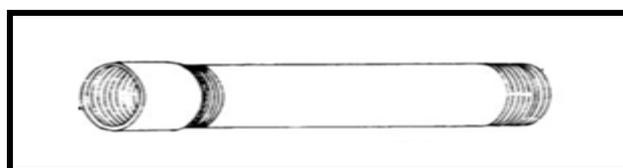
Tubo conduit metálico rígido de pared gruesa
